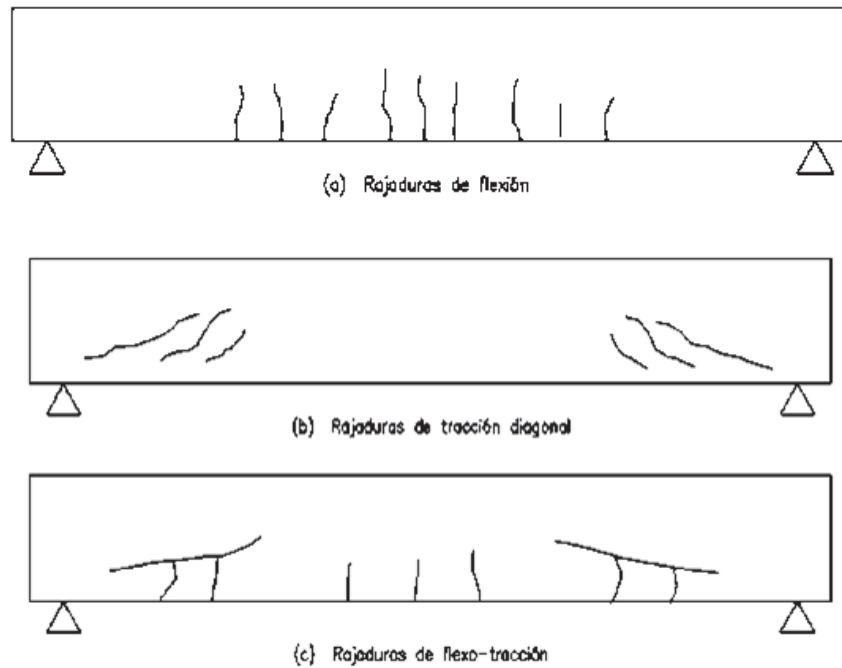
Tipos de fisuras que presentan las vigas de concreto armado (McCormac & Brown, 2018)
